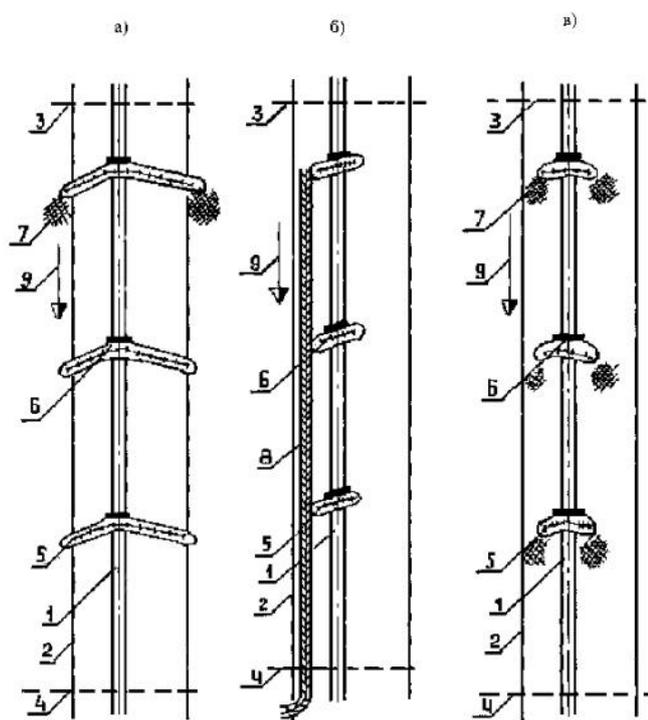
Варианты расположения открытого дренажа на продольном склоне (план). а) с отводом стока за пределы полосы трубопровода; б) с отводом стока в водосбросный лоток; в) с отводом стока на участки поверхностного закрепления грунта. 1 - валик засыпки трубопровода; 2 - граница строительной полосы трубопровода; 3 - верх склона; 4 - низ склона; 5 - водоотводящие валики; 6 – траншейные перемычки; 7 – участки поверхностного закрепления грунта; 8 - водосбросный лоток; 9 - направление уклона местности
